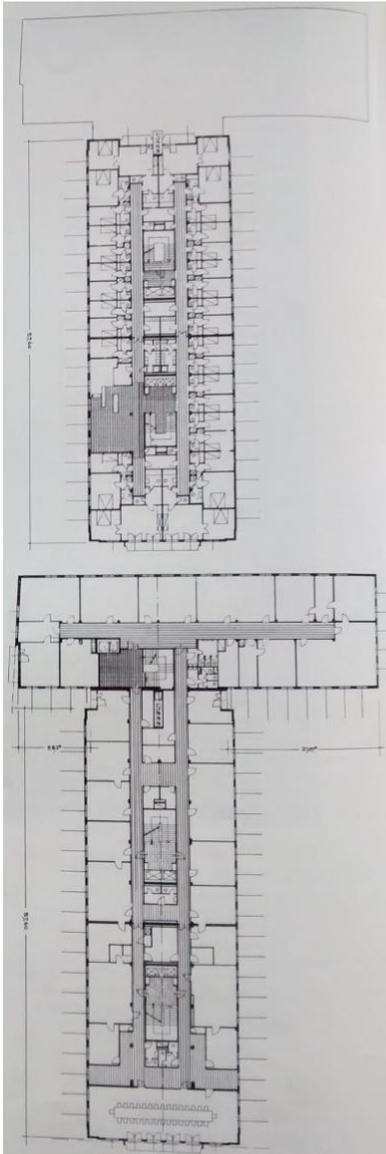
Gartenbauhochhaus, Hotelgeschoß (oben), Bürogewölb (unten)
